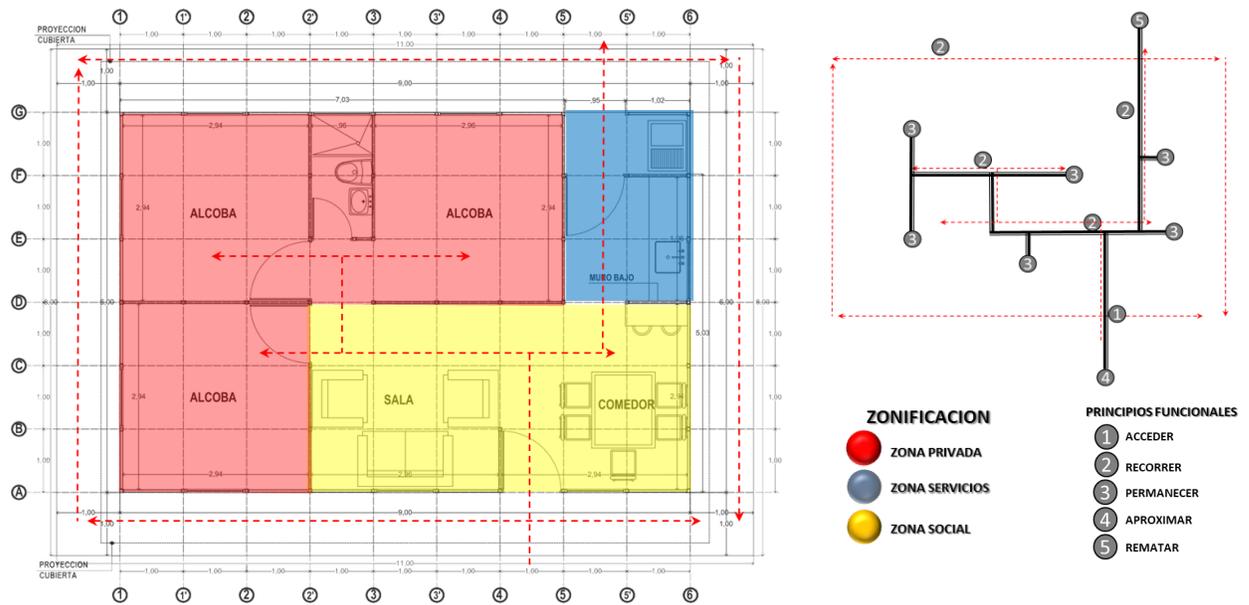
Planta Distribución Vivienda Rural 54m<sup>2</sup>, Fuente: Elaboración propia.
